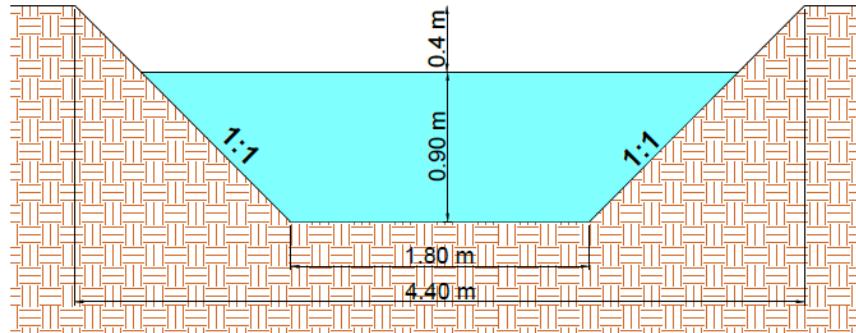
Sección típica del aliviadero, [Elaboración propia, 2021]
